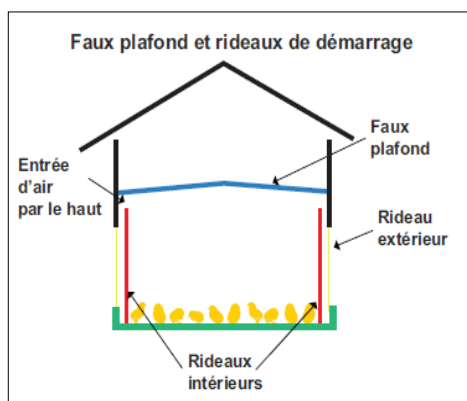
Exemple de faux plafond et rideaux de démarrage (guide poulet de chair)
